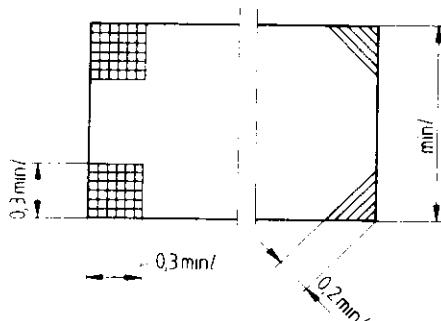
Rechtwinklige und schräge Eckbewehrung, Unterseite
